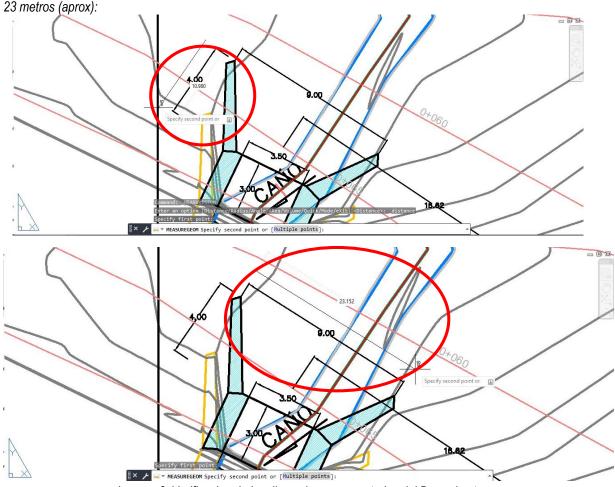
Verificacion de las dimensiones proyectadas del Box culvert.
